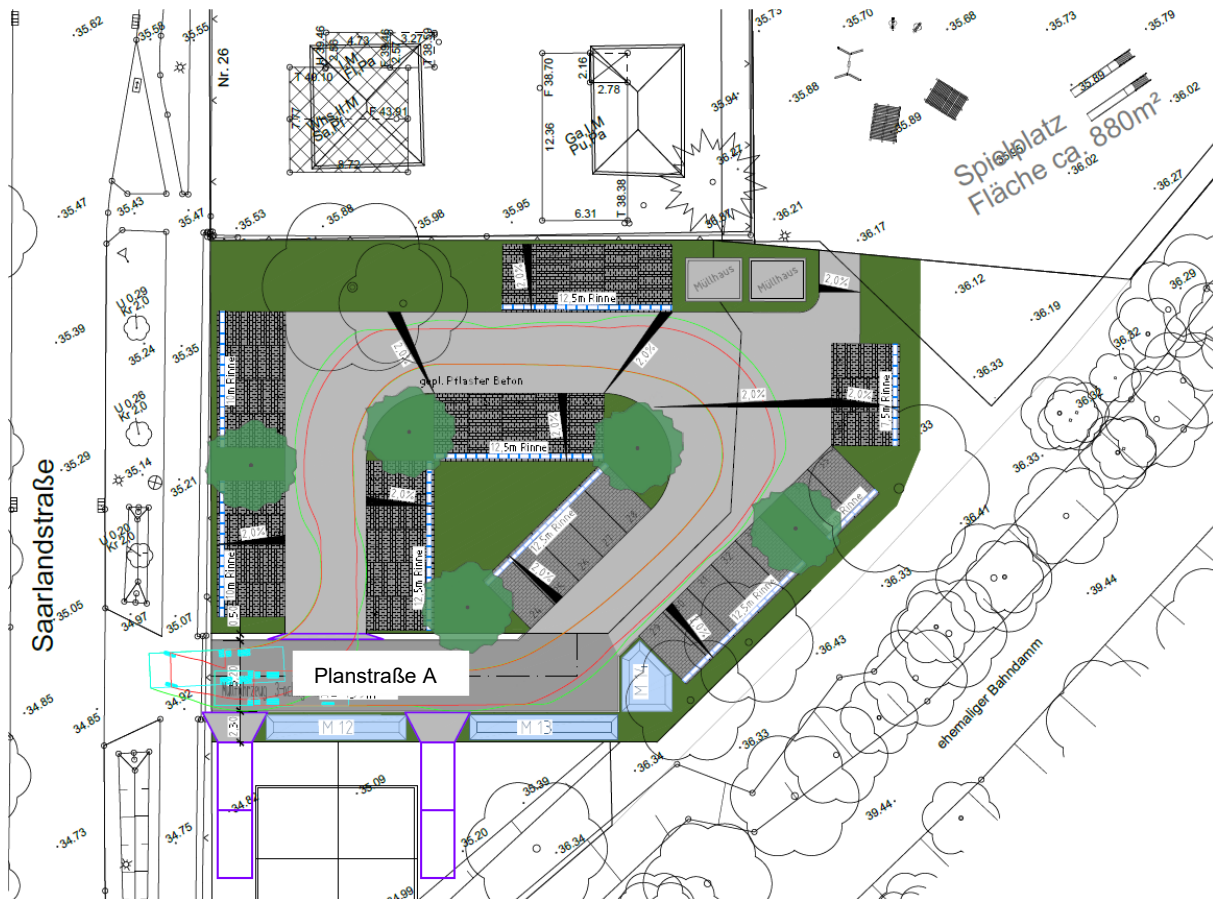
Planung Straßenbau Planstraße A inkl. Anwohnerparkplatz (Infraconsult Beratungsgesellschaft im Ingenieurbau GmbH, September 2025)
